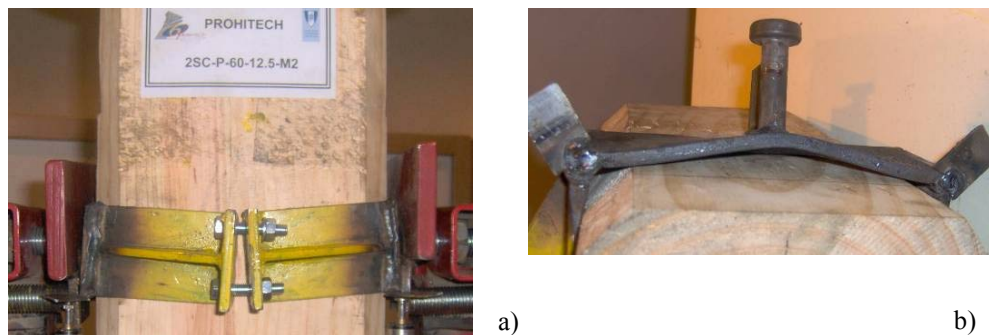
Danni rilevati a fine prova 2SC-P-60-: a) Serraggio a 12.5kN; b) Serraggio a 250kN.
